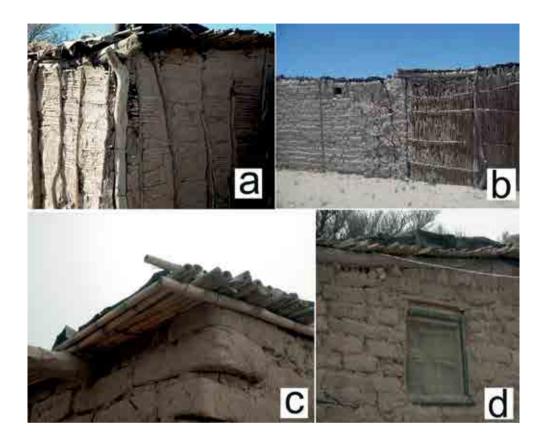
Materiales del espacio cerrado de la casa habitación: a) muro de quincha; b) muro combinado de quincha y adobe; c) detalle de cubierta y materiales empleados y d) ventana con dintel aislado y cierre liviano de nylon sintético por el exterior.
